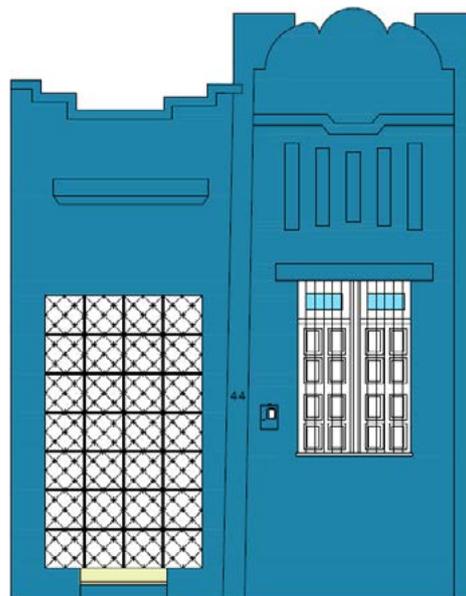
Casa localizada na Rua Teodoro Nascimento - Centro, Lagarto – SE.
